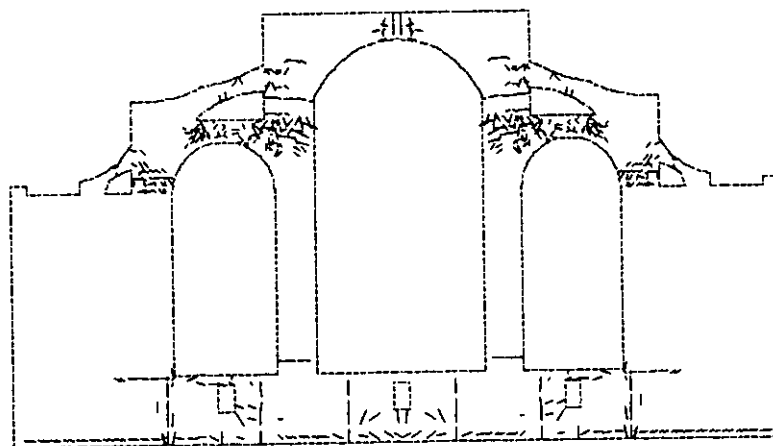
Configuración de grietas por asentamiento parabólico en la base
